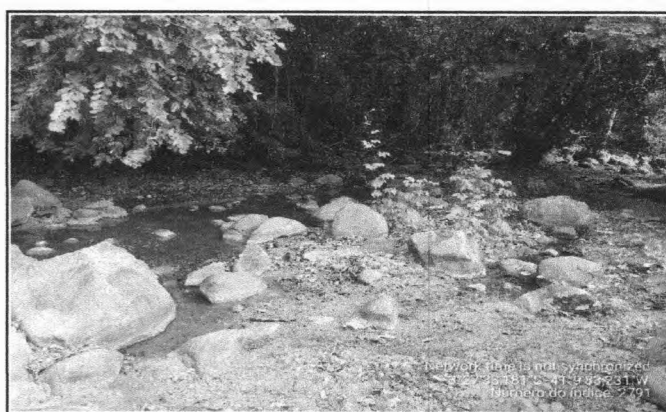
LOCAL DA CONSTRUÇÃO - BUEIRO
